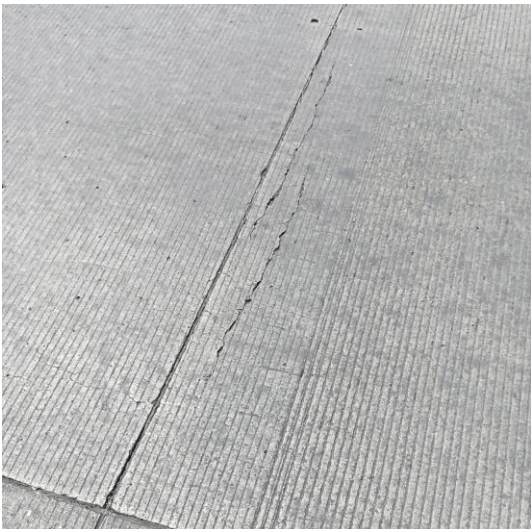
Esquema del deterioro “grieta de durabilidad o tipo D” (vista en planta)
